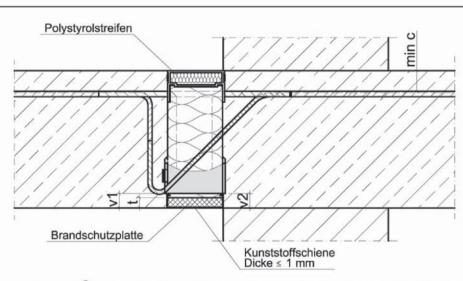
Schöck Isokorb® Typ K und Typ KF (Ausführungsvariante B) gem. Abschnitt 3.1.2
